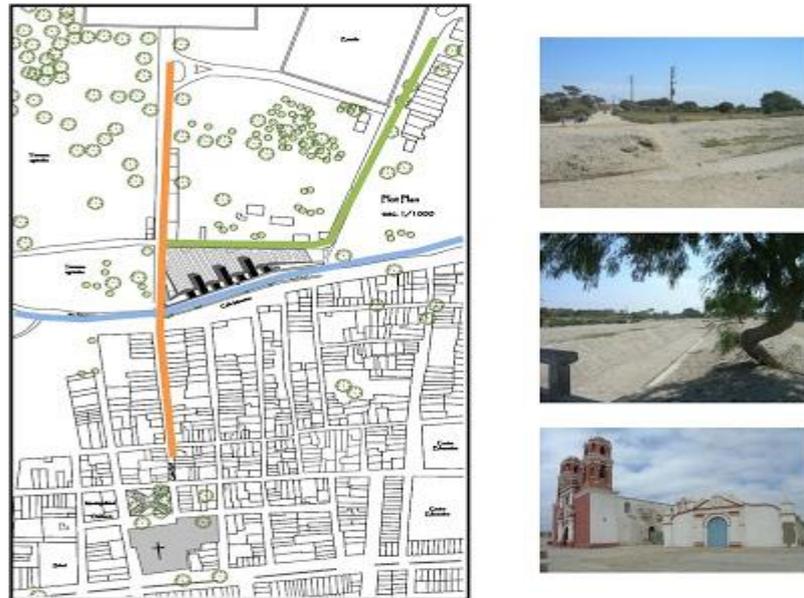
Planteamiento arquitectónico: Centro Artesanal Textil – Algodón Nativo de Lambayeque
